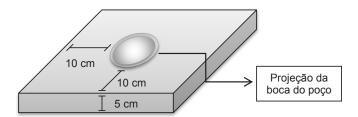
Desenho esquemático da laje de proteção sanitária do poço.
